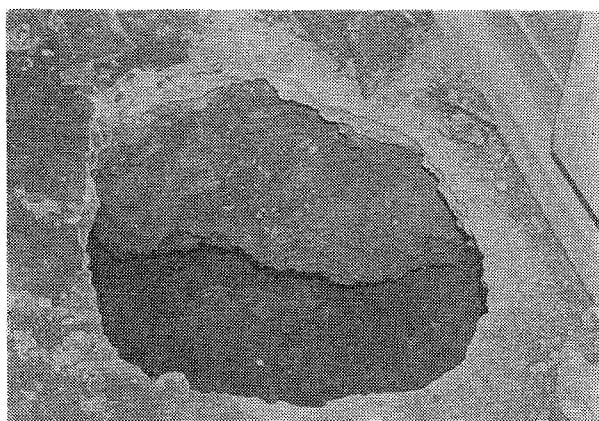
鉄筋建物コンクリート土間の下に巣をつくっている状況
